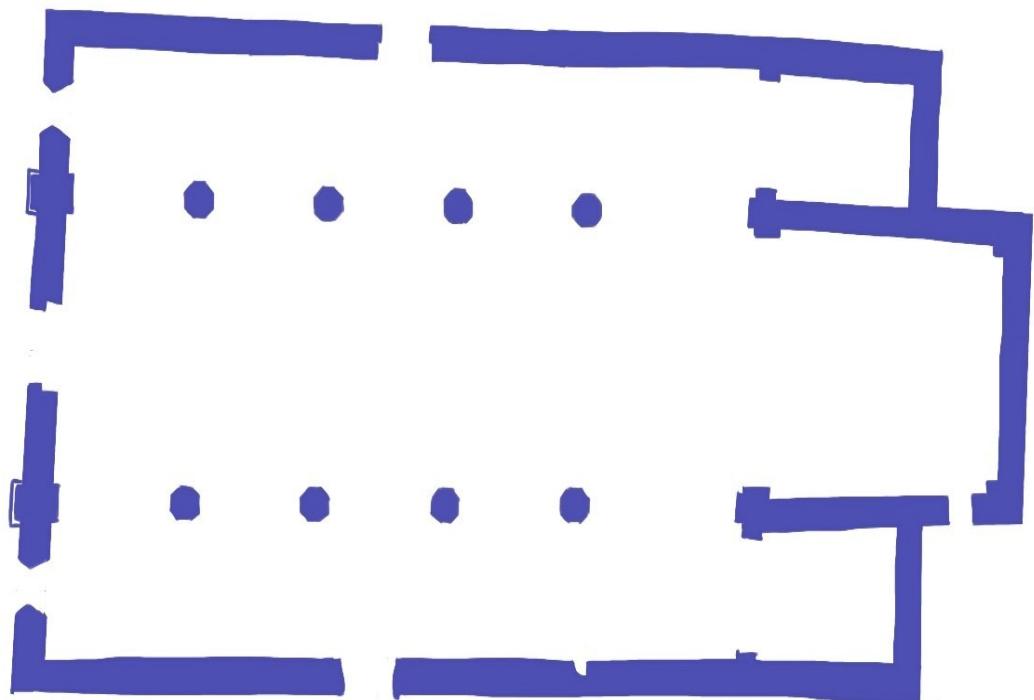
San Giovanni Decollato, Grundriss des gotischen Umbauphase der Kirche
